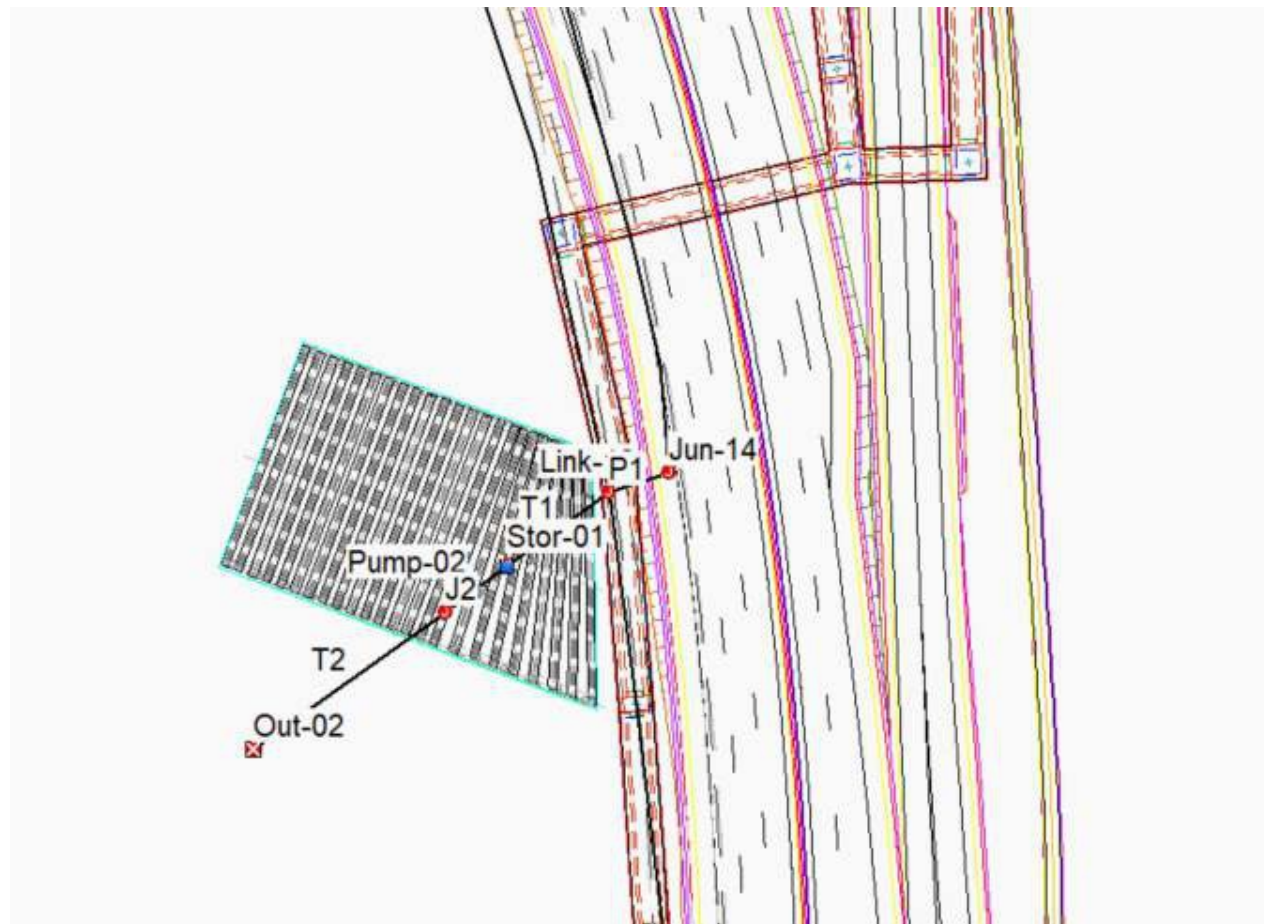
Planta de SSA ubicada en la estación del bombeo
